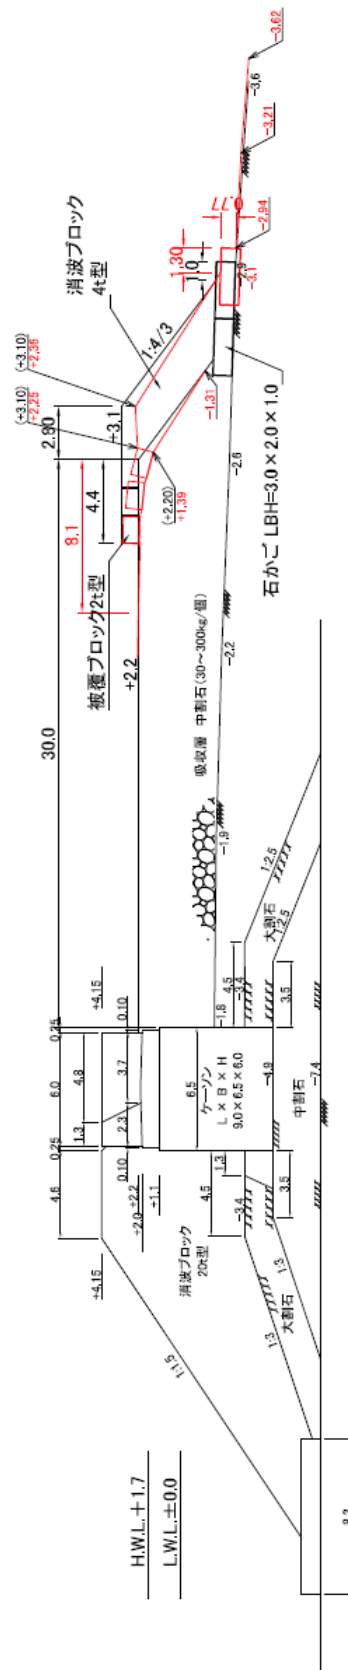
No. 1 西港外港地区東防波堤の断面図 (被災前・被災後)
